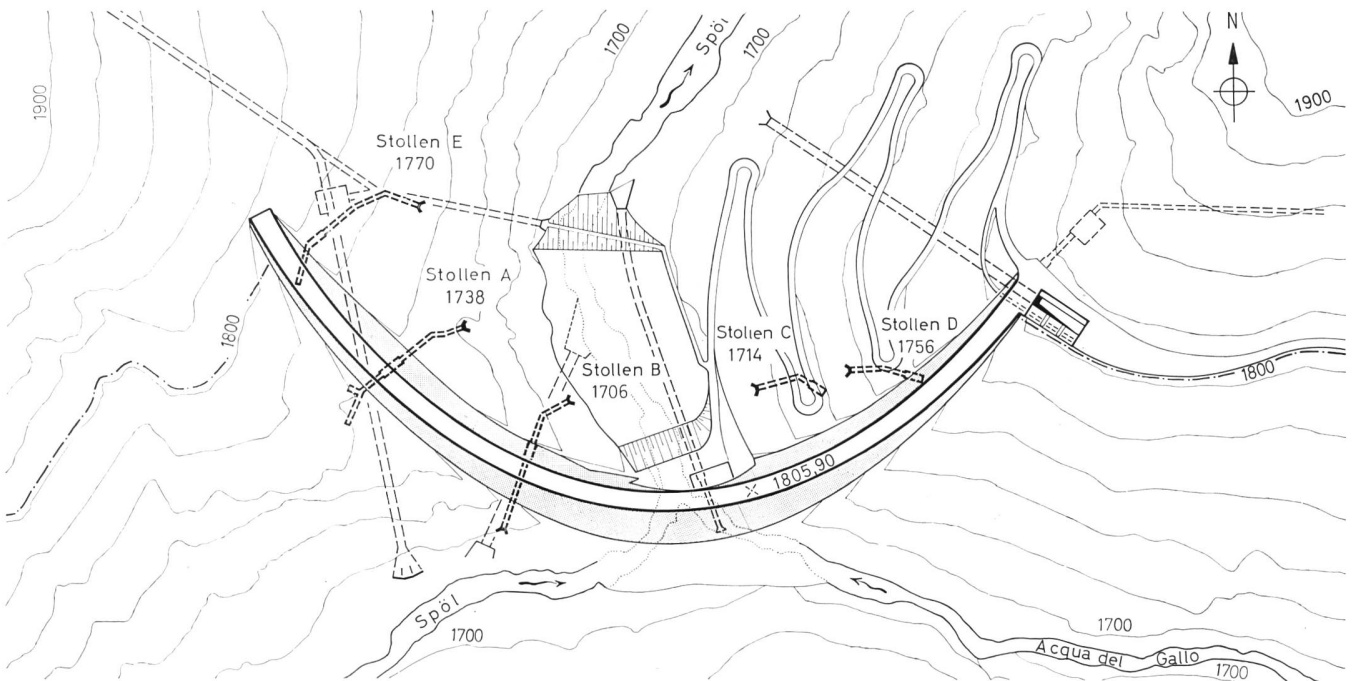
Lageplan der Sperrstelle Punt dal Gall mit Sondierstollen, Massstab 1:4000 (Cliché SBZ)
